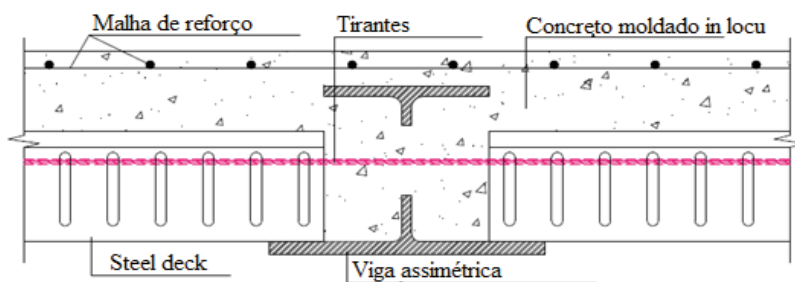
Shallow Cellular Composite Floor Beam (SCCFB)
